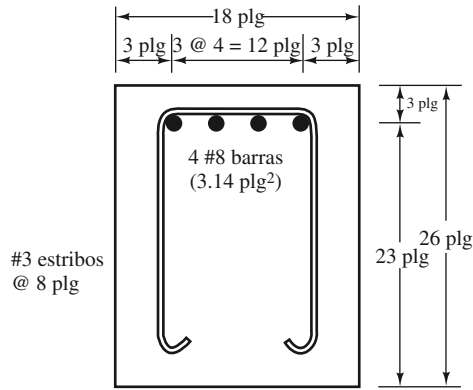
Sección transversal de la viga en voladizo del Ejemplo 7.4.
